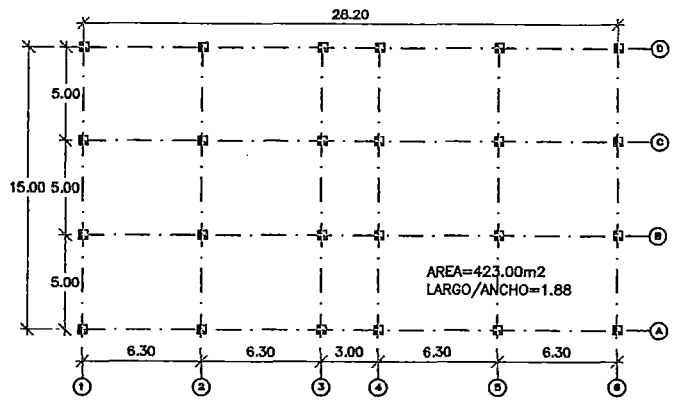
DIMENSIONES M02 PLANTA TIPICA
